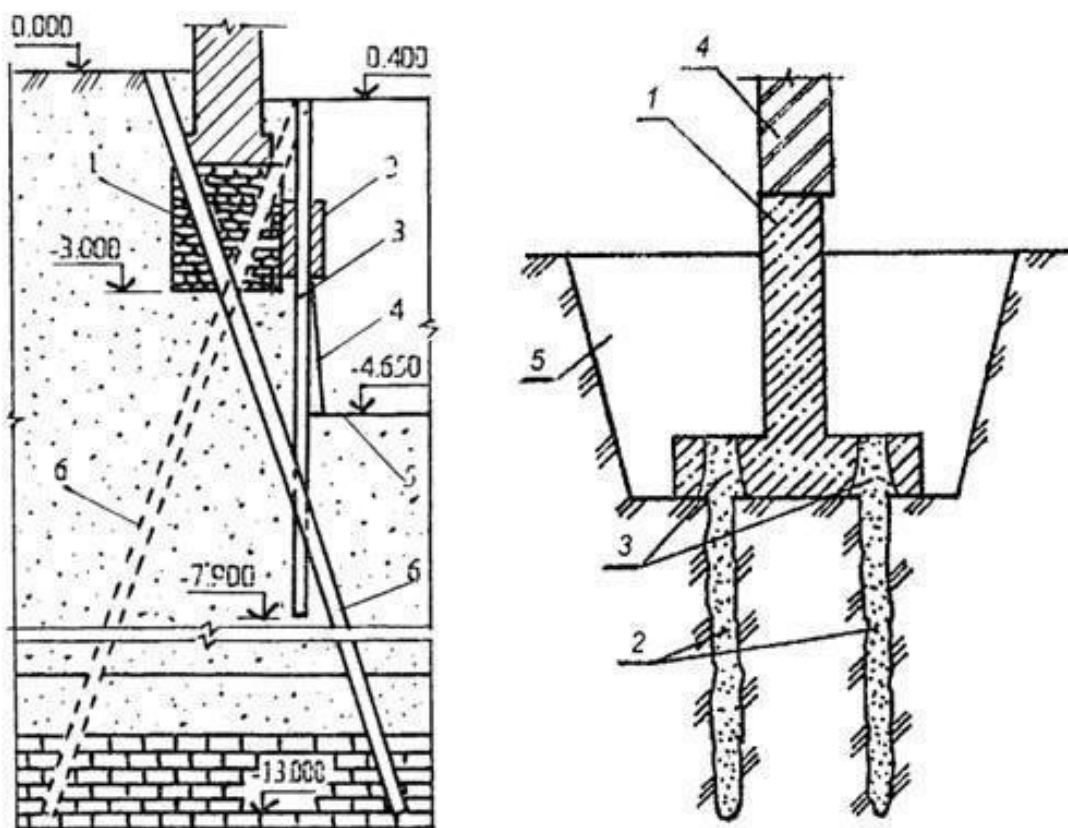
Приклади підсилення фундаментів бурін'єкційними палями: 1-існуючий фундамент; 2-ростверк; 3-паль підпірної стіни; 4-відкіс котловану; 5-дно котловану; 6-похилі бурін'єкційні палі;
